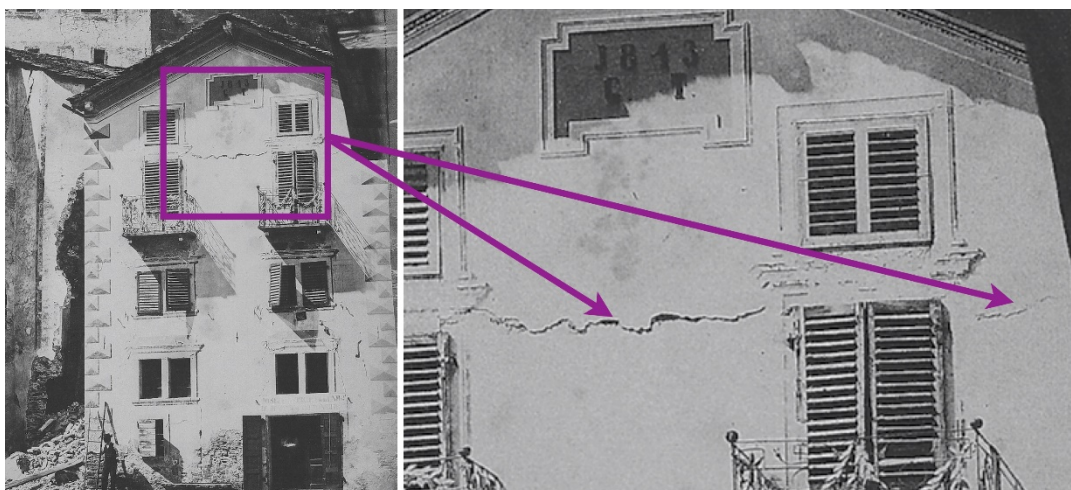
Tremblement de terre à Stalden-Viège en 1855. Fissure horizontale avec écaillage du plâtre dans le mur pignon d'un bâtiment en maçonnerie de pierre naturelle à Viège dans le canton du Valais (source : CREALP, Sion) : [degré de dommage 2](#)
